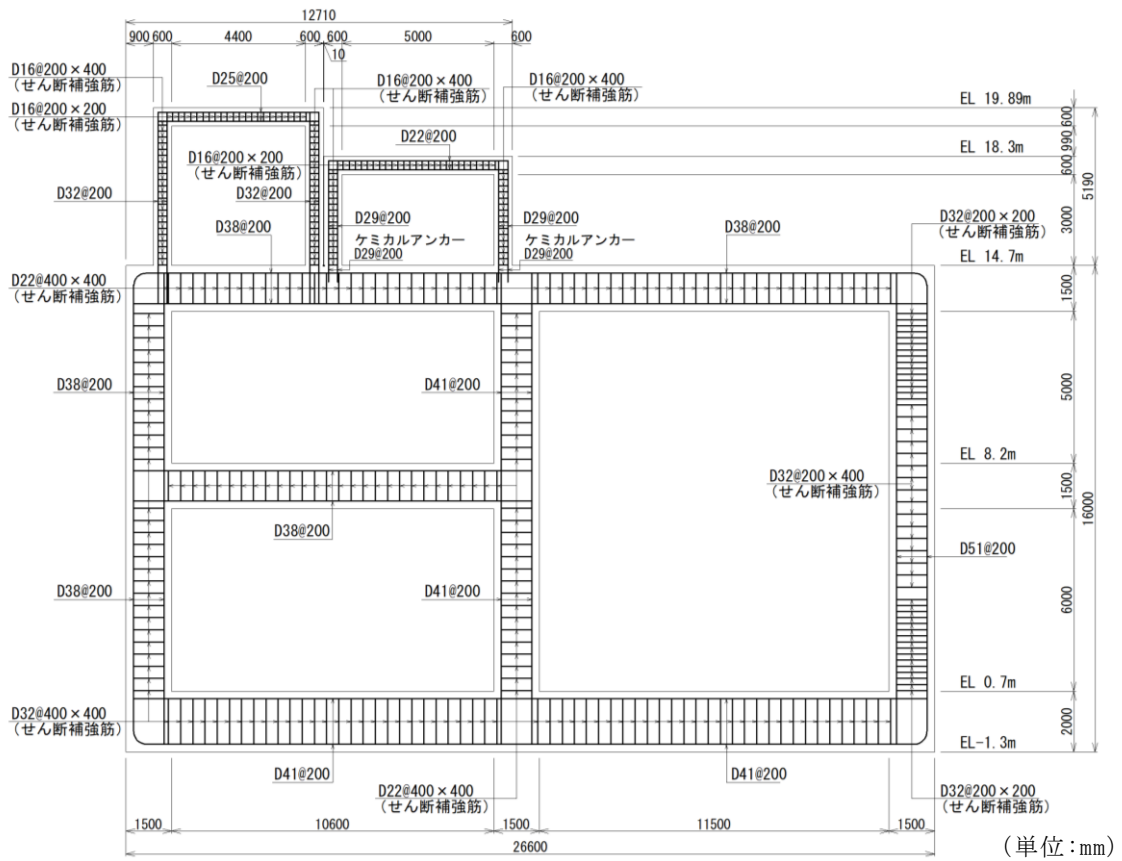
低圧原子炉代替注水ポンプ格納槽 概略配筋図 (C-C 断面)
